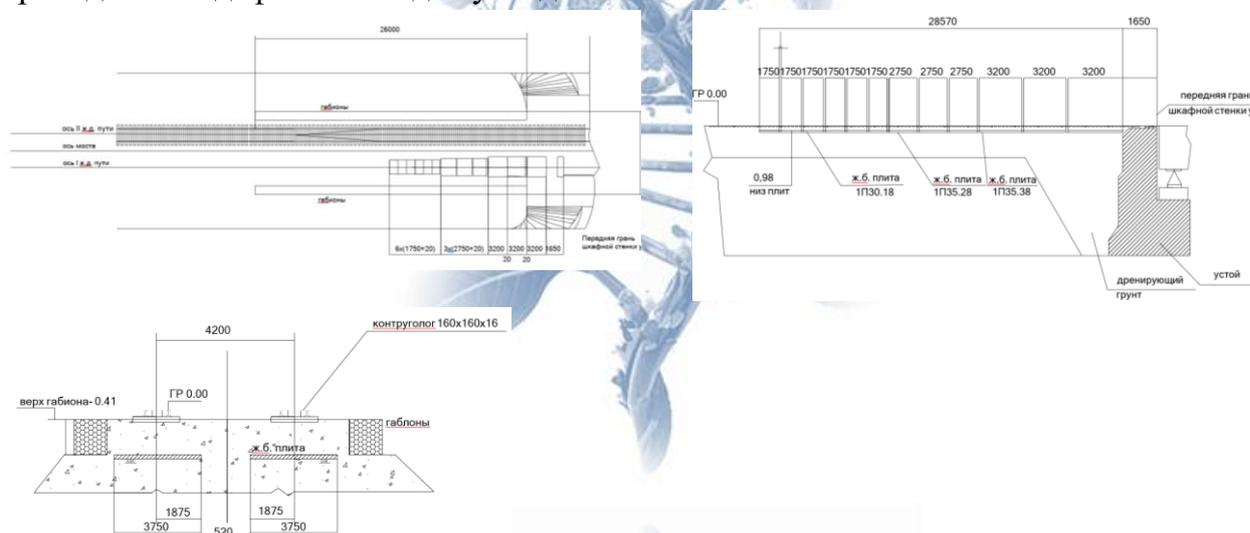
Конструкция участка переходного пути с подбалластными железобетонными плитами
